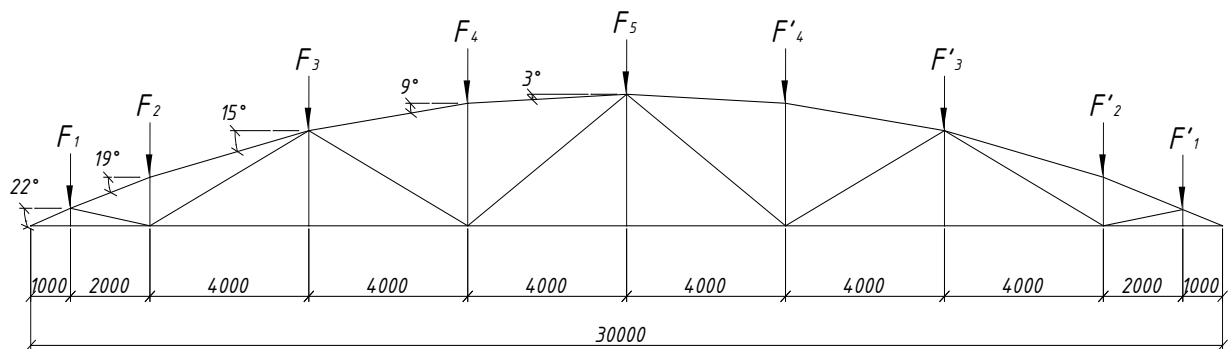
Нагрузка, прилегающая на каждый узел фермы
